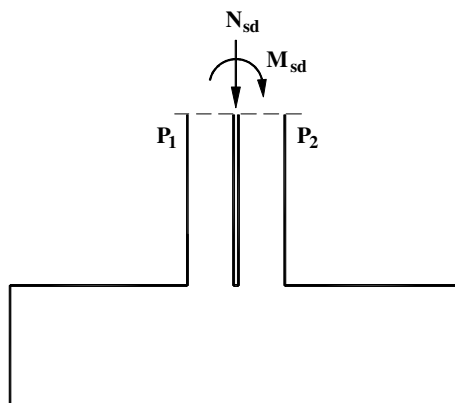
Sapata conjunta aos pilares P₁ e P₂.
